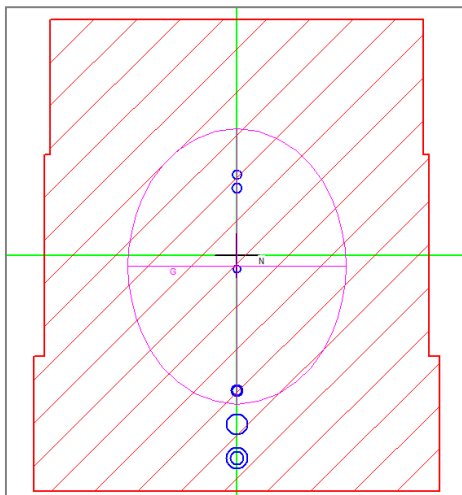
trave in C.A.P. e getto di completamento, sezione omogeneizzata
